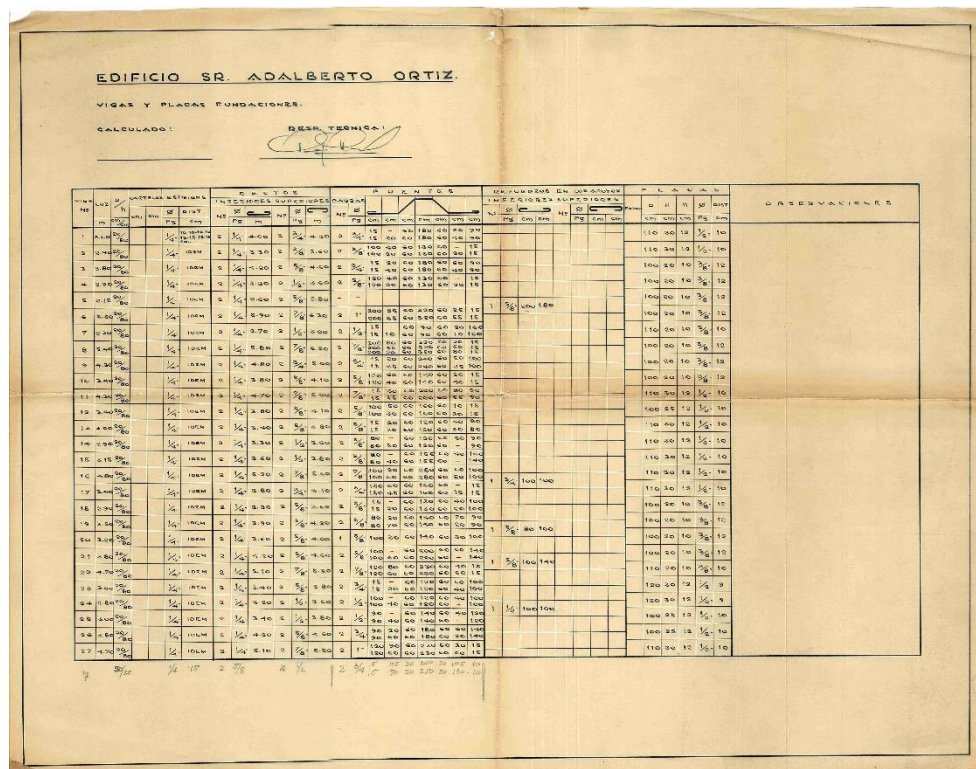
Plano de vigas y placas fundaciones del proyecto Edificio Sr. Adalberto Ortiz (Archivo Rivas, 1961)
